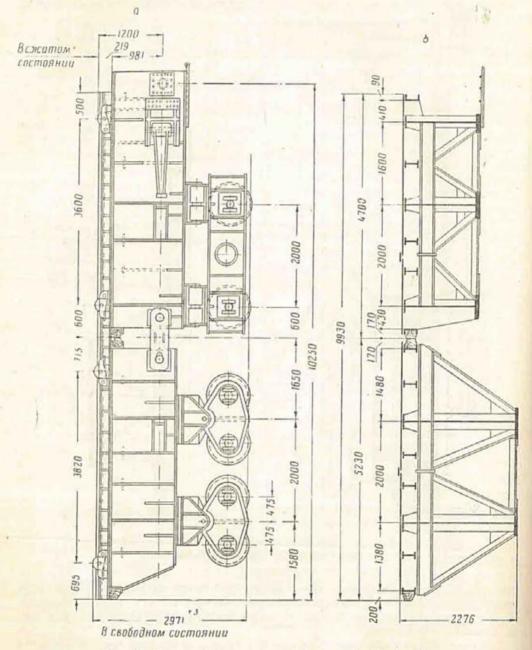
Плоский сдвоенный затвор с Γ -образной верхней частью: a-вид с торца; δ -вертикальный разрез.
